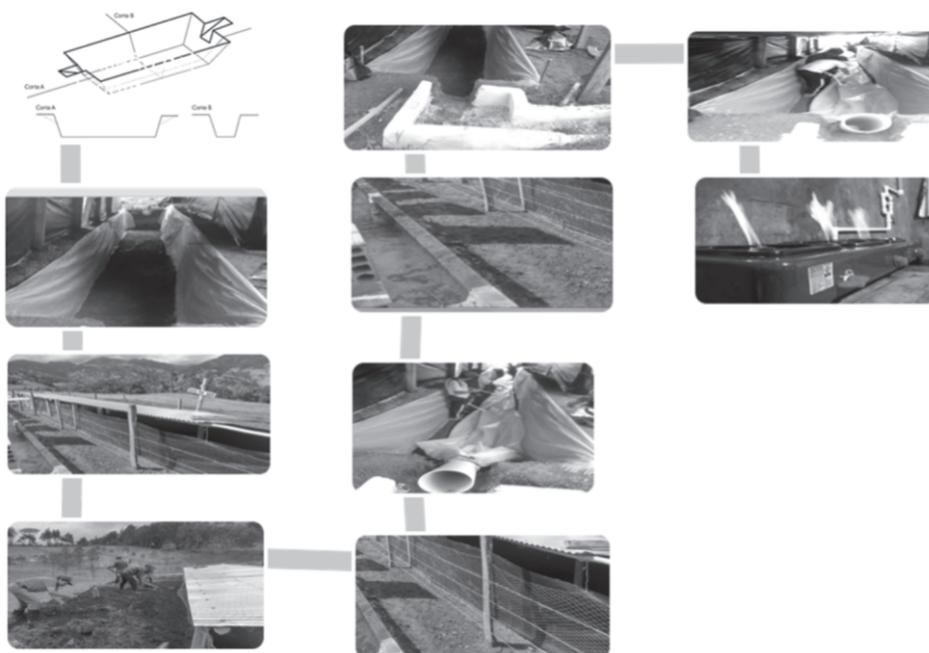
Secuencia de construcción del proyecto. *Fuente:* autores.
